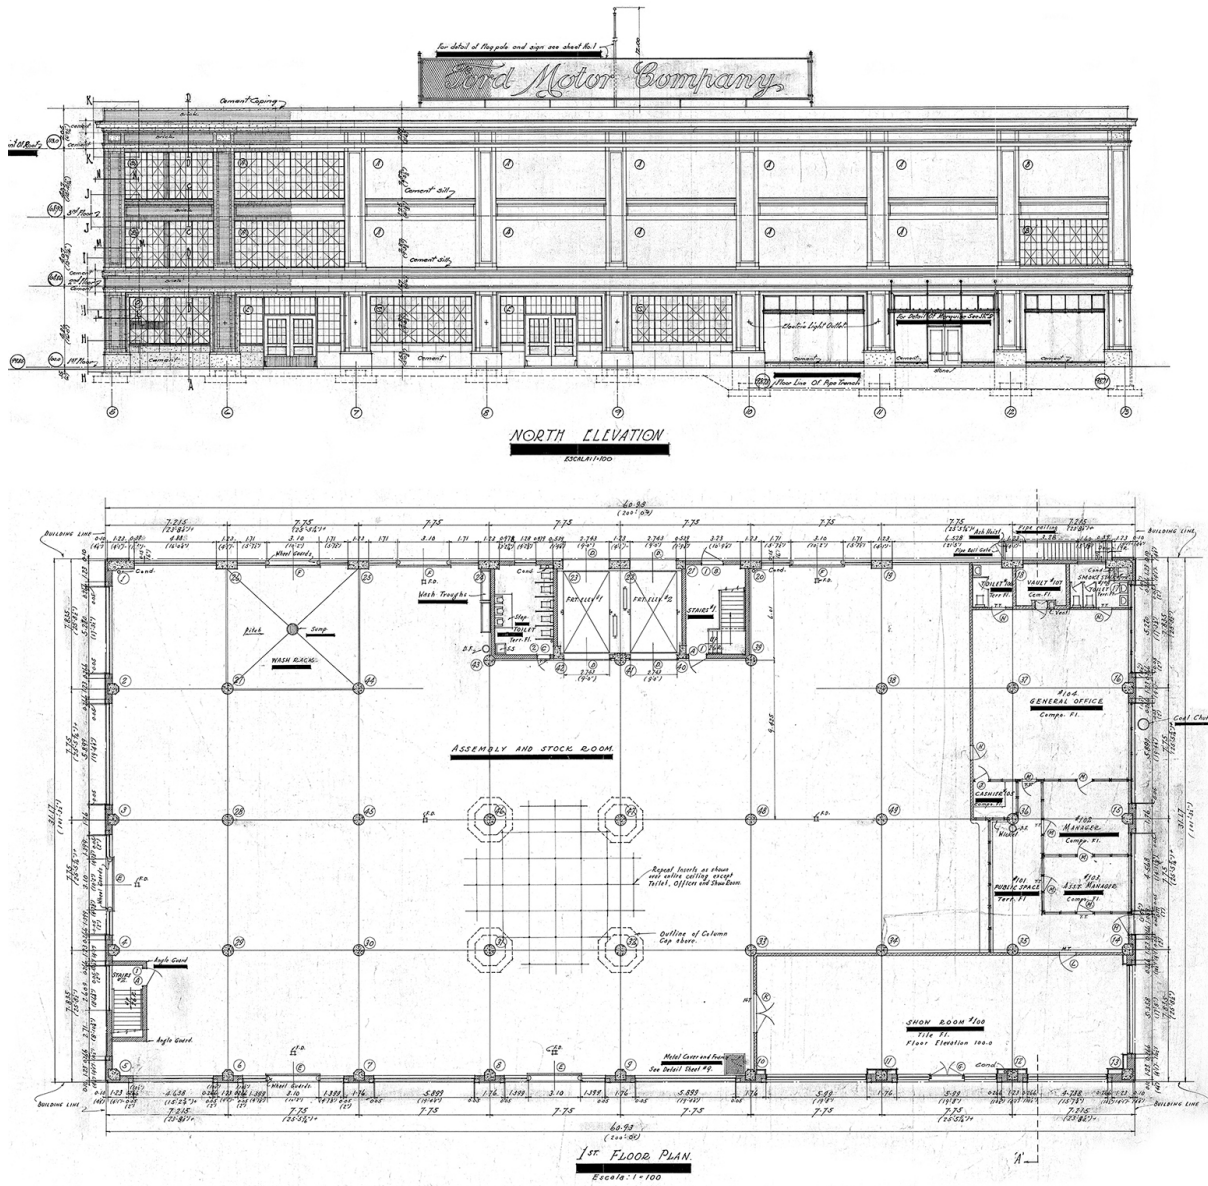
Fachada principal da Rua Solon e planta baixa do primeiro pavimento.
